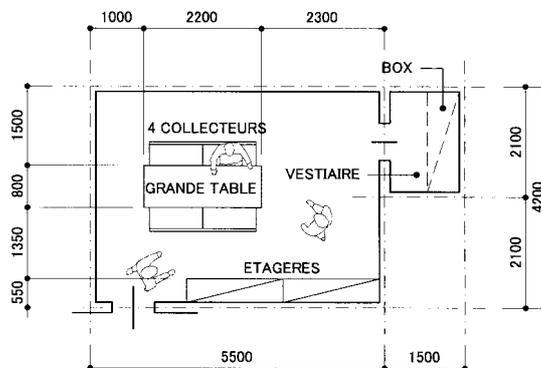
Plan planimétrique du bureau des collecteurs du comité
